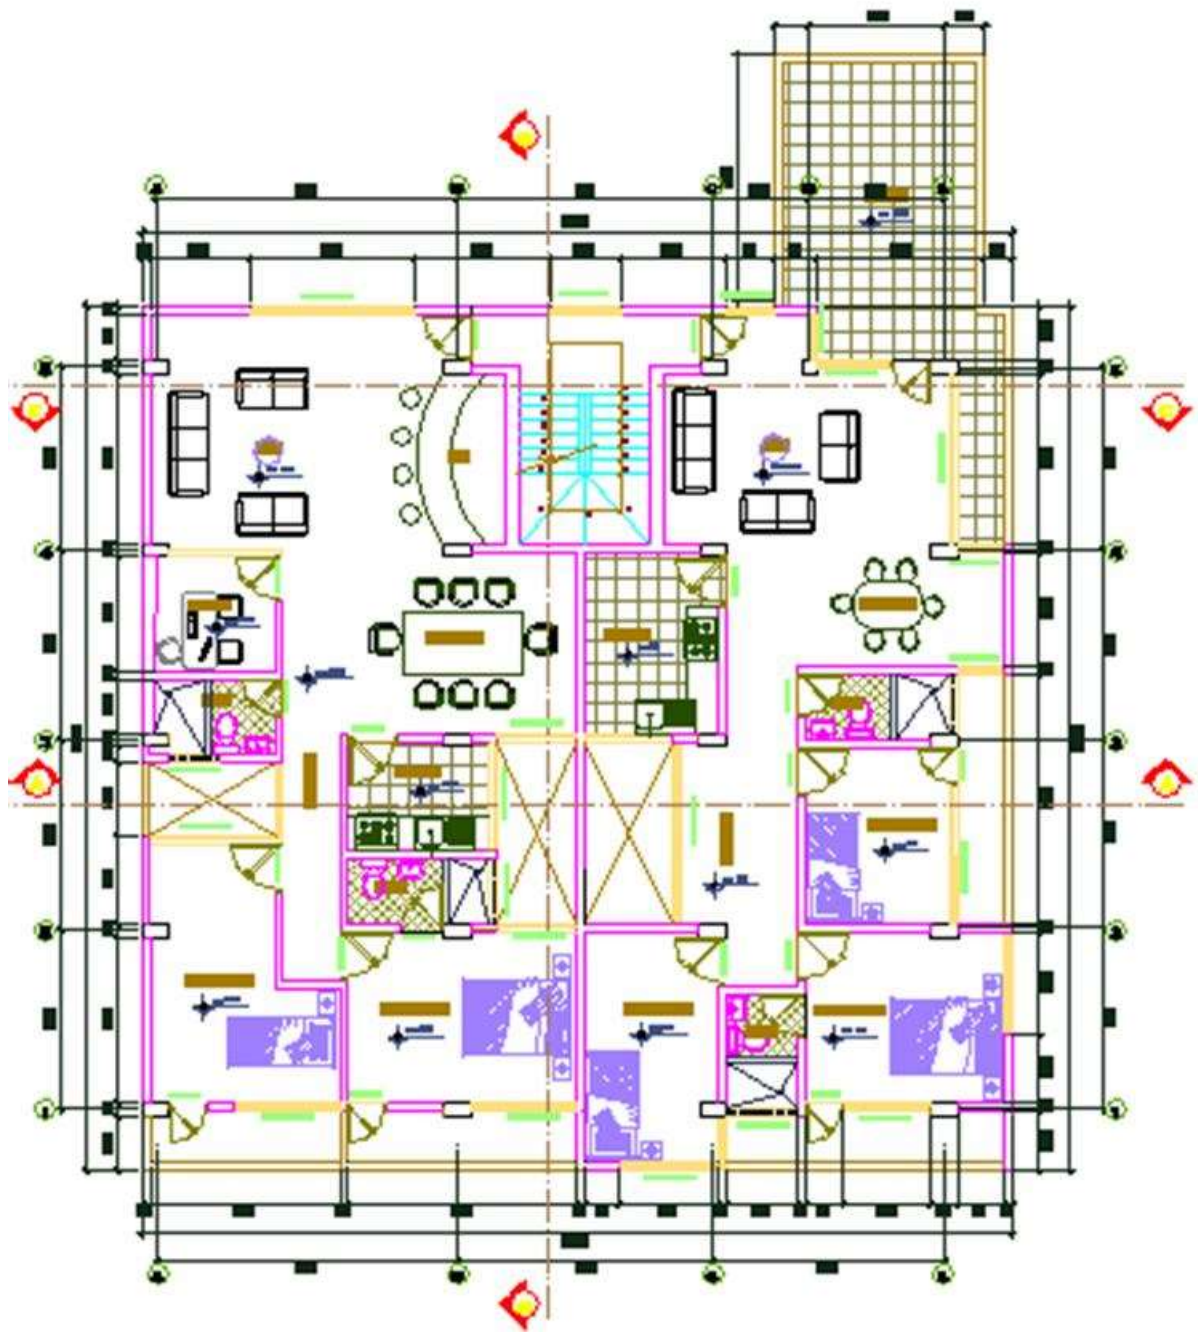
Arquitectura típica de la planta del 2do al 5to piso del edificio
